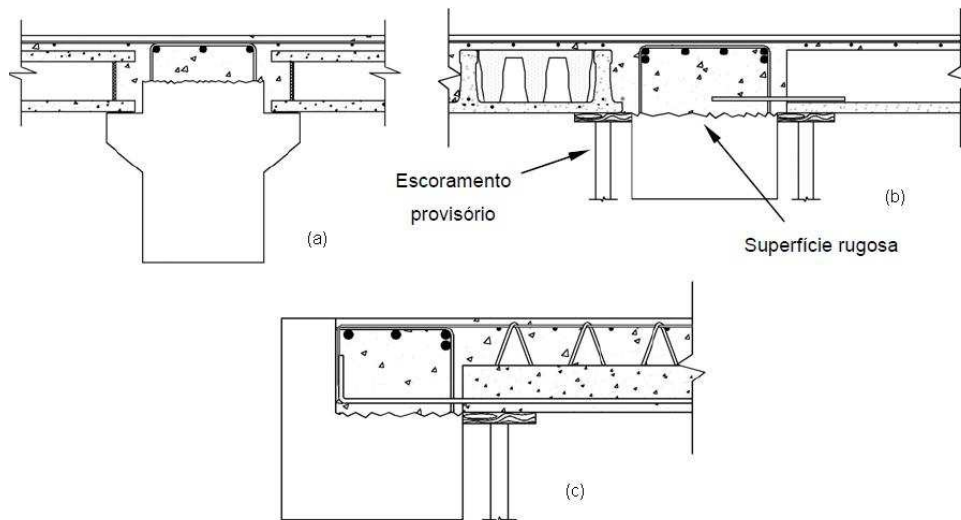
Exemplo de ligação viga - pilar – laje (adaptada de [20])
